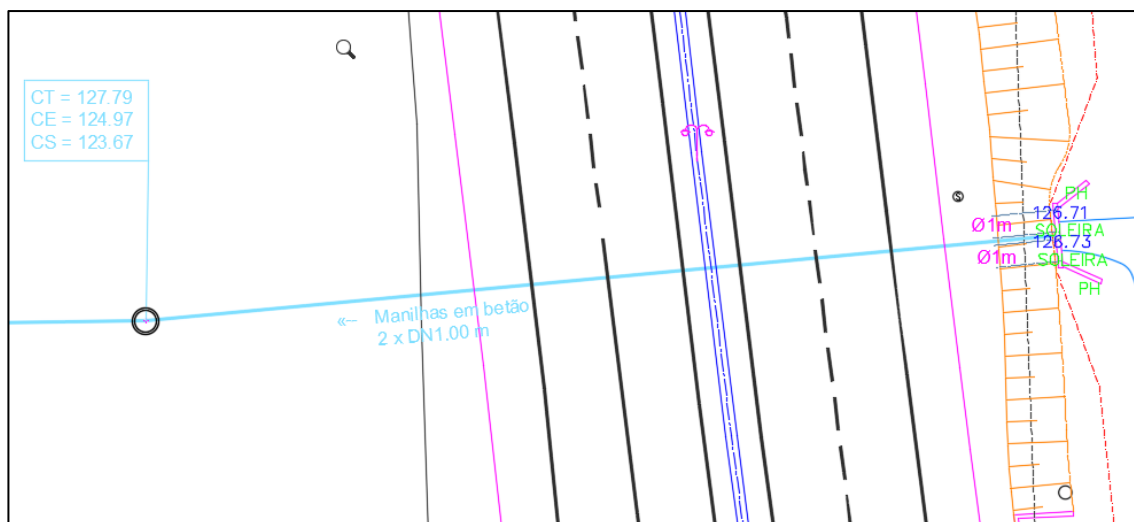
Planta do Levantamento da PH existente (Extracto)
